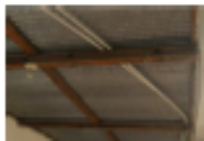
Vista exterior de la letrina cubierta por riel y cofa seca.
